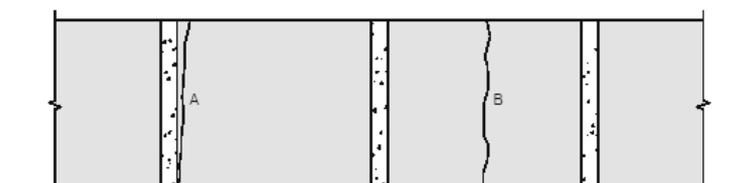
Fissuras verticais causadas por movimentações térmicas: a) destacamento entre alvenaria e pilar, b) fissura no corpo da alvenaria
